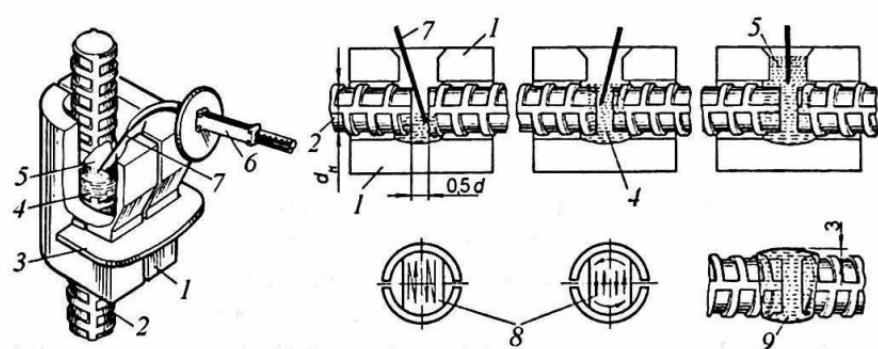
Полуавтоматическая ванная сварка арматурных стыков:
